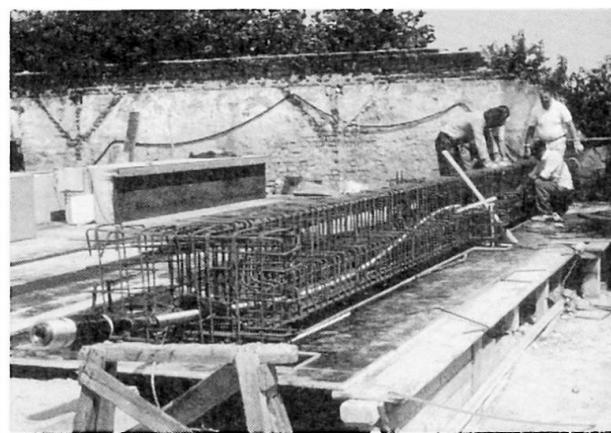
Neuer Fertigteilbalken, Bewehrungskorb mit HLV-Spannglied
